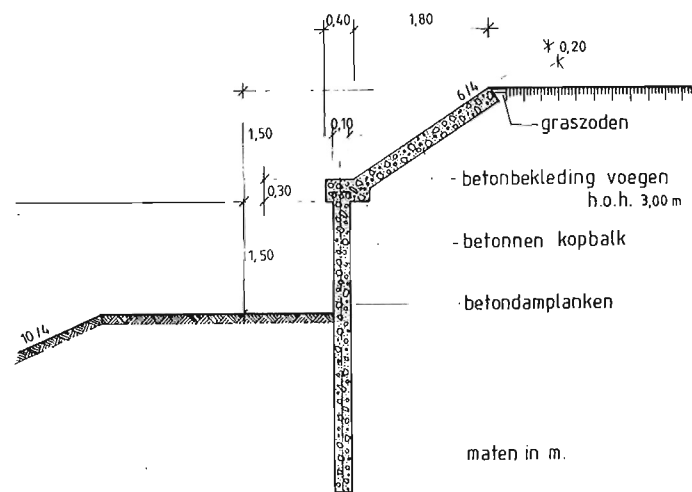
doorsnede van oeverbekleding langs het kanaal Milaan-Cremona-Po.
